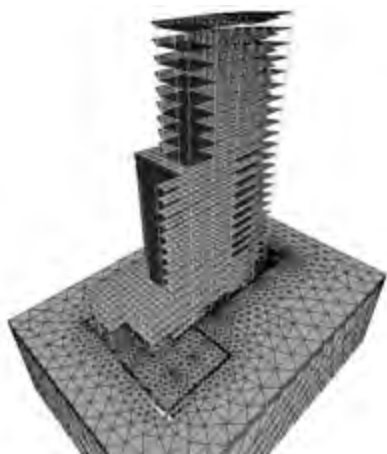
Конечно-элементная модель системы здание — фундамент — грунтовый массив
